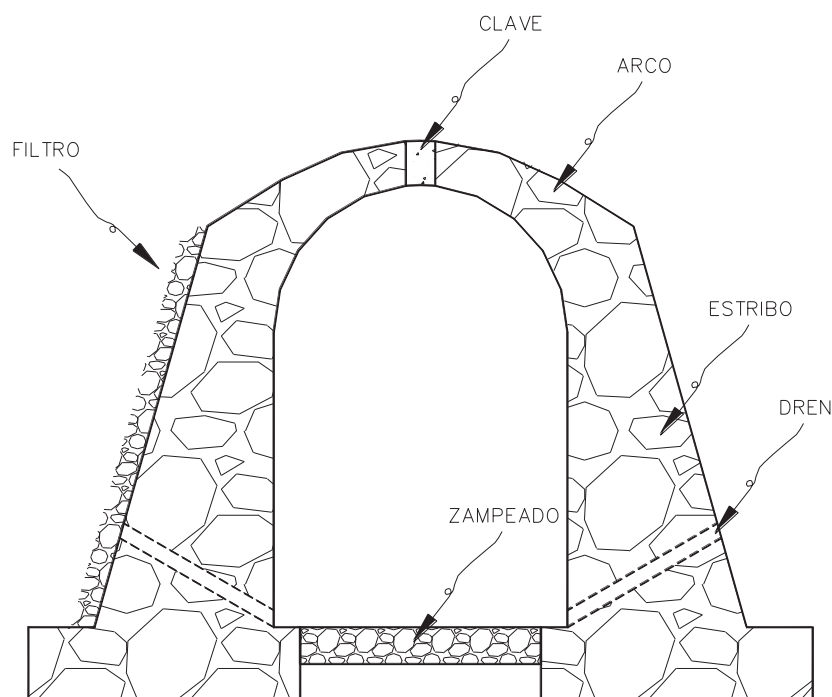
Alcantarilla de bóveda de medio punto (Corte transversal).
